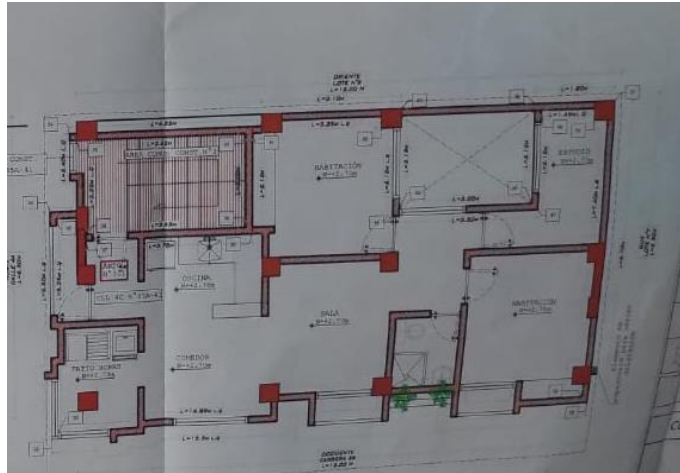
Plano distribución niveles 2,3,4,5
